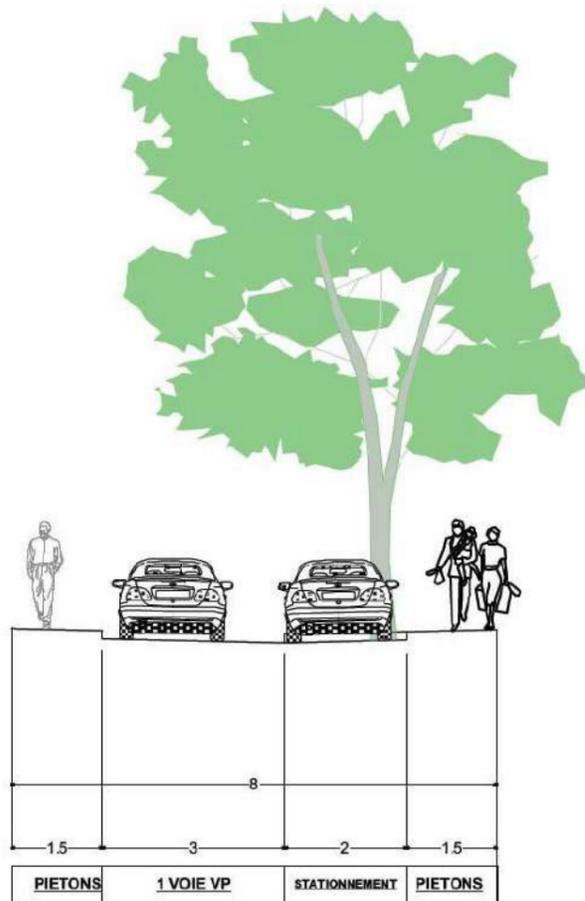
Profil en travers type d'une voie pavillonnaire uni directionnelle
